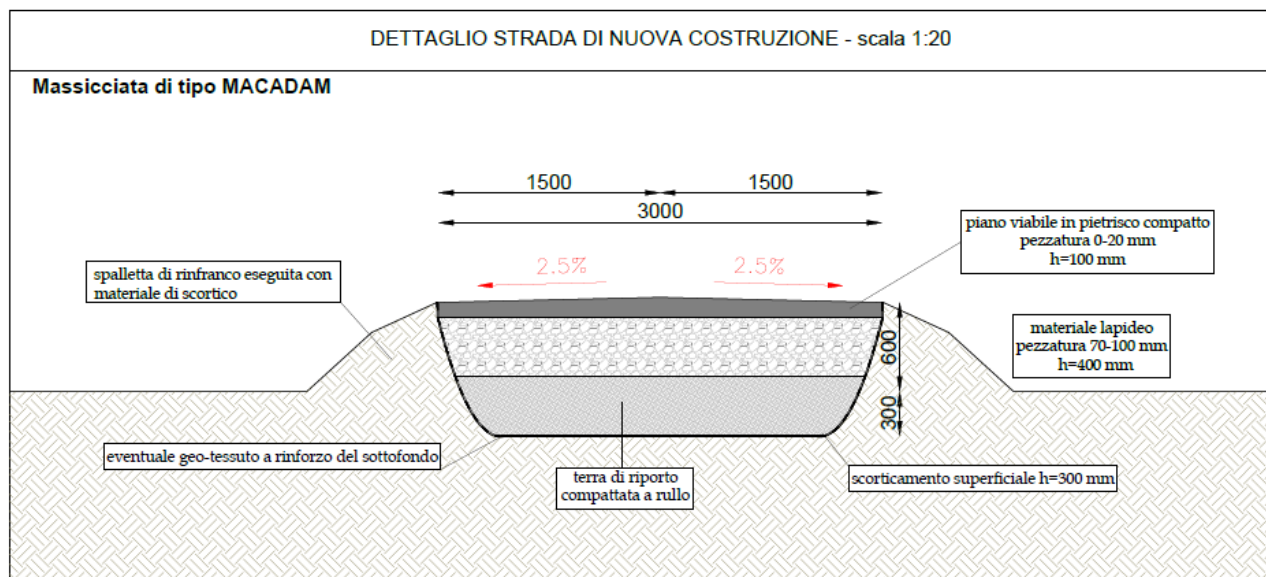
Particolare della sezione delle strade di nuova costruzione
